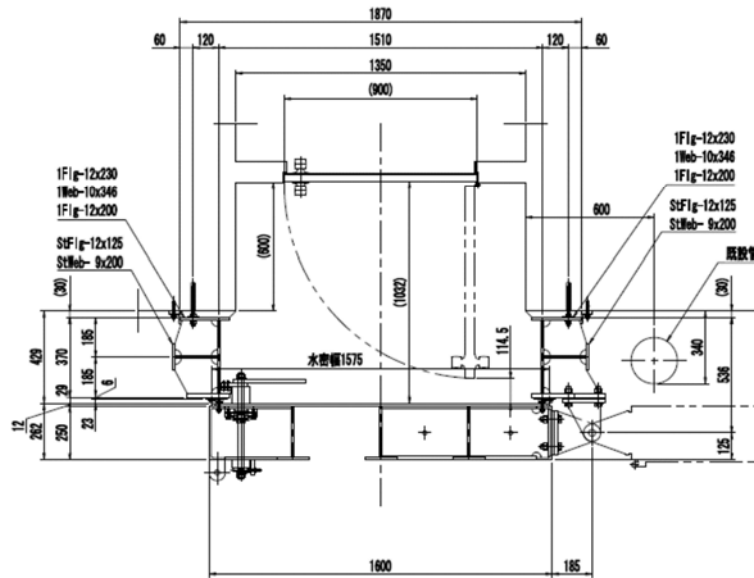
浸水防止扉 (TVF-3) の構造図 (単位 : mm)
